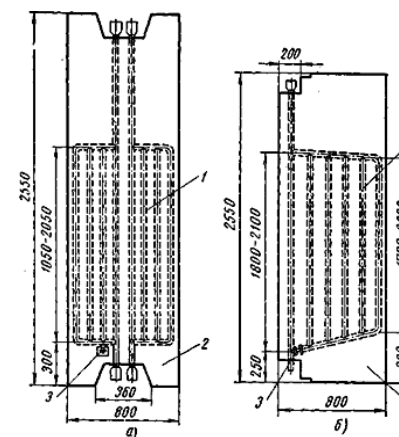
Перегородочные бетонные отопительные панели: а – для двухтрубной системы отопления; б – для однотрубной системы отопления; 1 – водяные трубы (нагревательные элементы); 2 – бетонная панель; 3 – регулировочный кран
